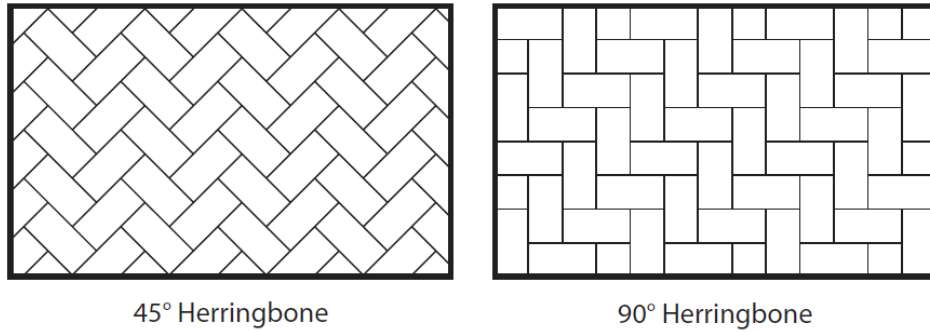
Patrones de colocación tipo espina de pescado a 45° y 90° (Interlocking Concrete Pavement Institute, ICPI)
